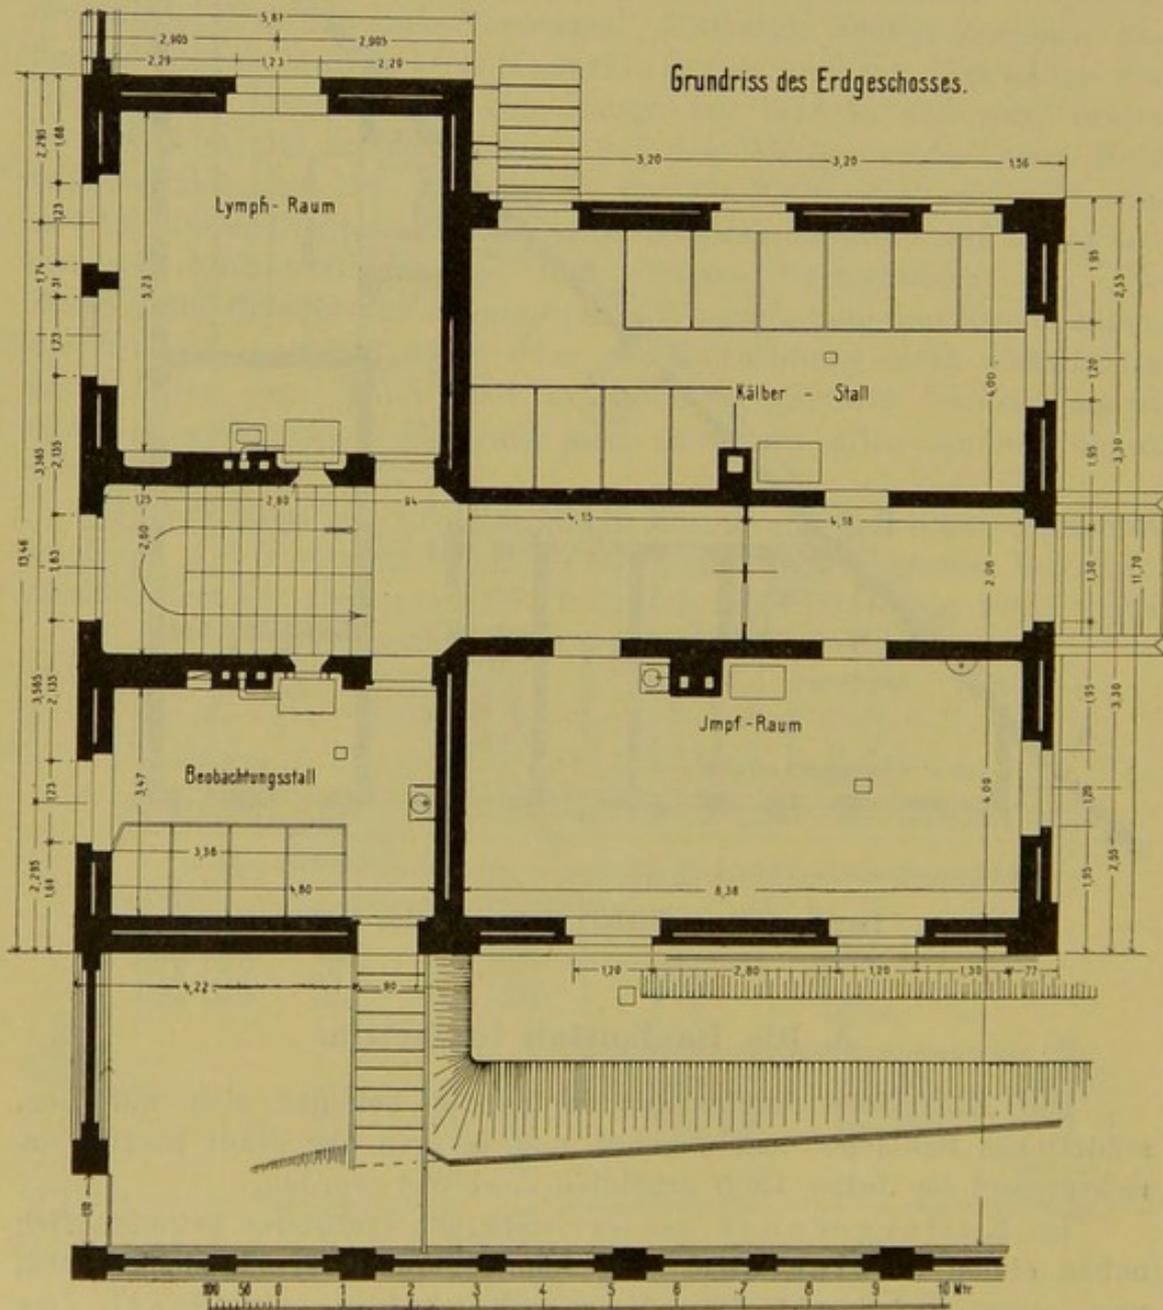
Impfanstalt in Stettin: Grundriß des Erdgeschosses.
